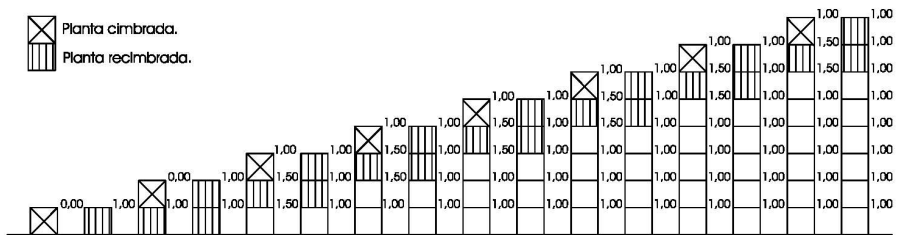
Factor de carga, en los forjados, con una planta cimbrada y otra recimbrada, en un edificio de ocho plantas, sobre solera infinitamente rígida.
